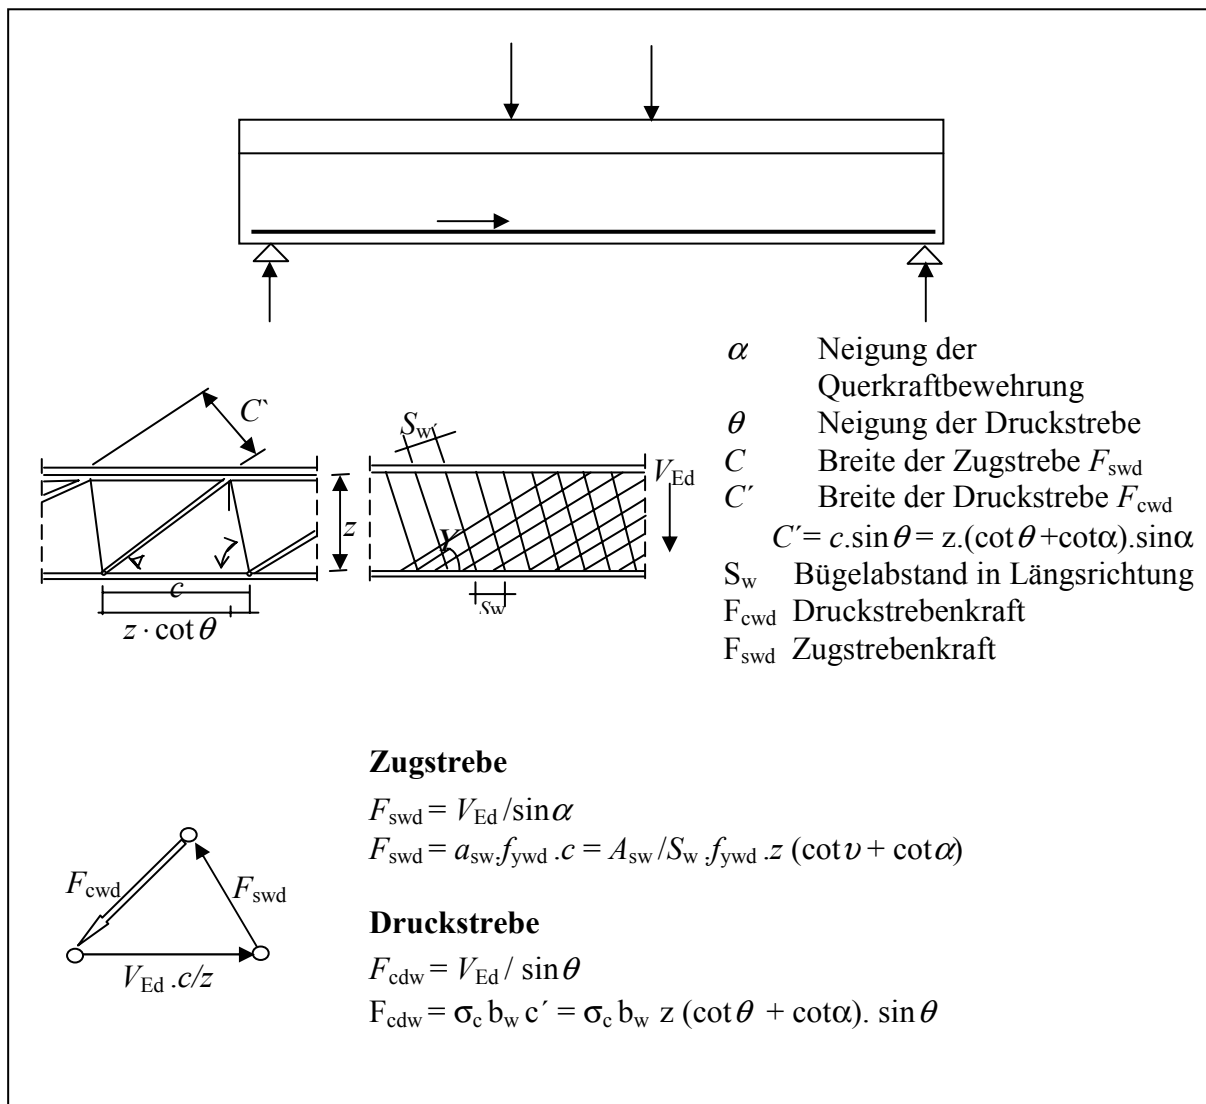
Fachwerkmodell für Bauteile mit Querkraftbewehrung [80]
